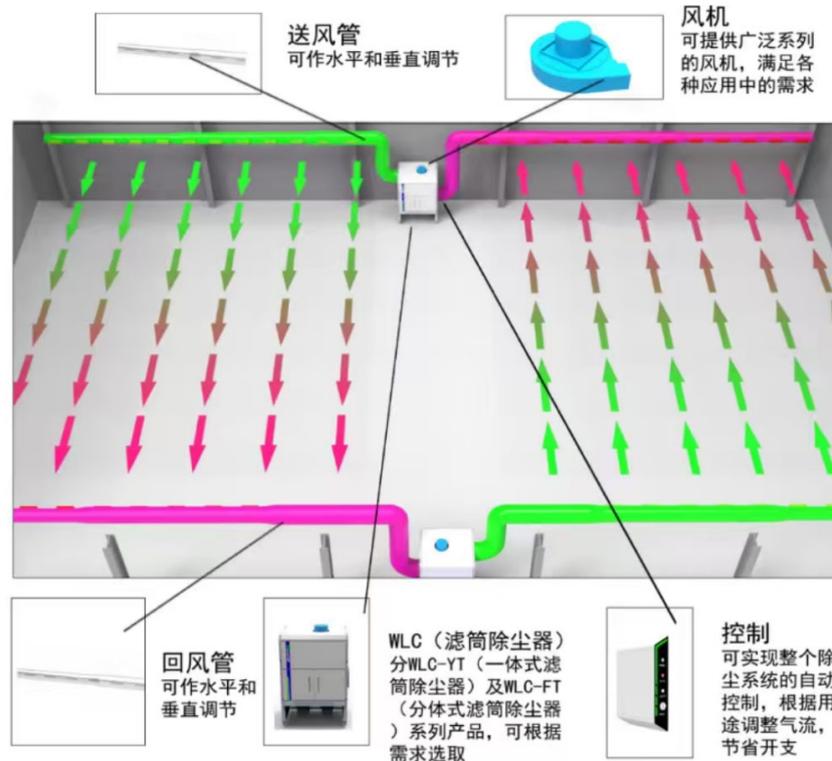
焊接烟尘抽吸式除尘系统工作原理示意图
